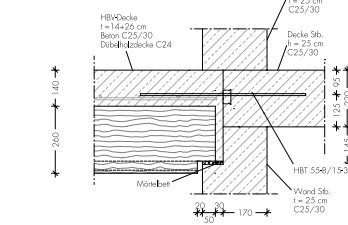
Auflager HBV-Decke auf Stb. II Spannrichtung
